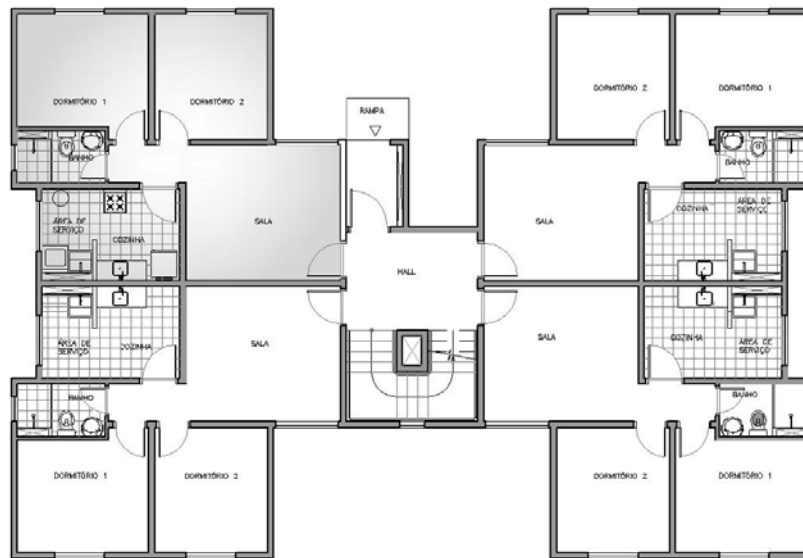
Planta pavimento tipo Conjunto Diamante – Tipologia de dois quartos
